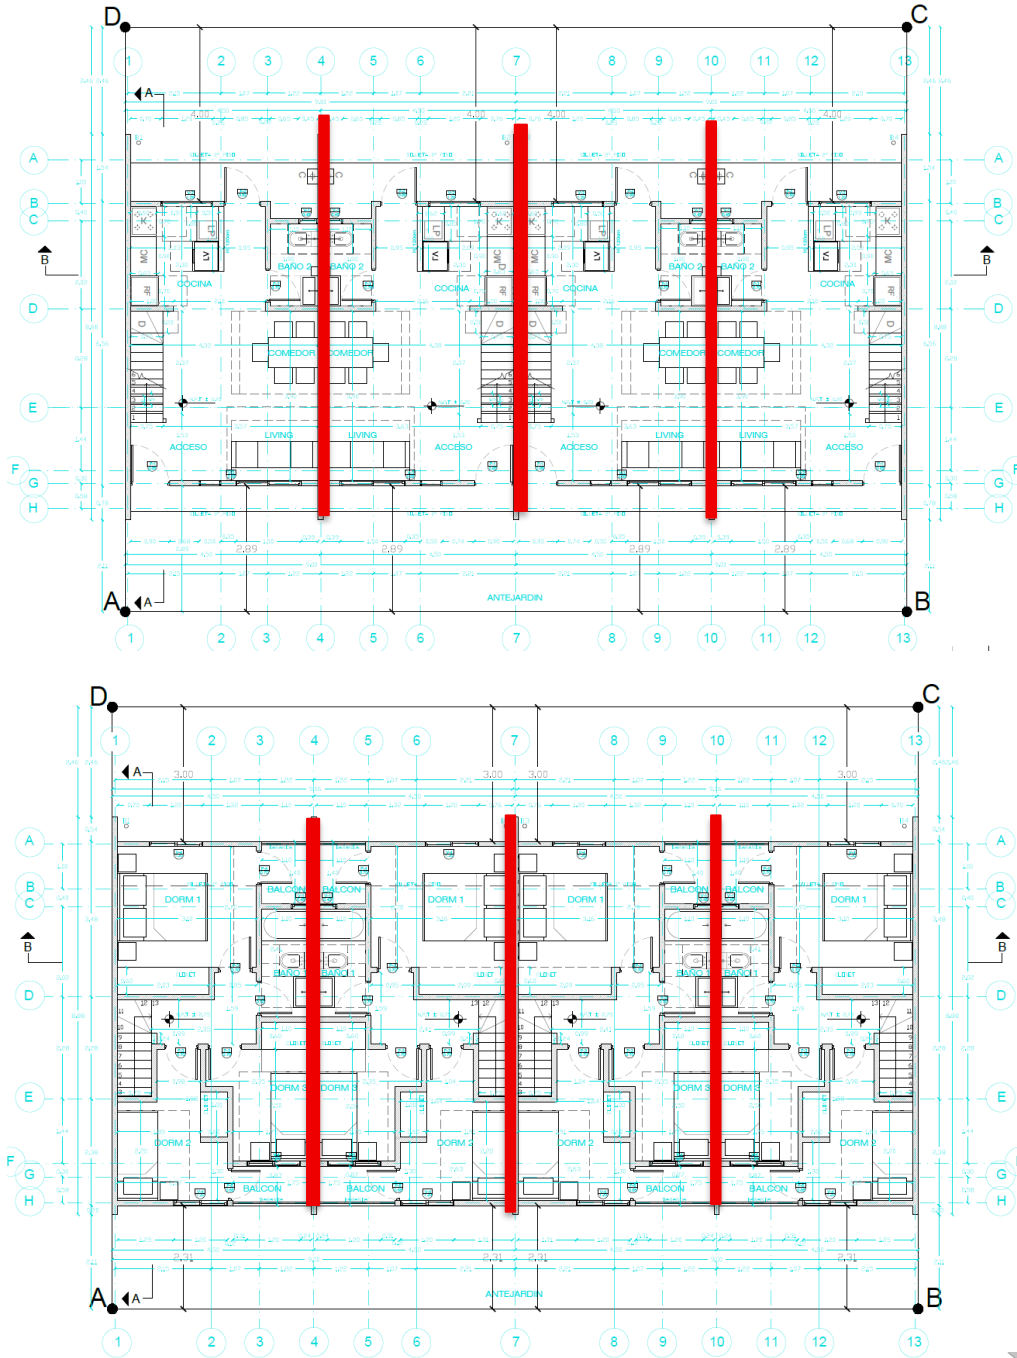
"Escantillón y vista en planta de la arquitectura de la vivienda; (Arriba) 1°Piso; (Abajo) 2°Piso".
